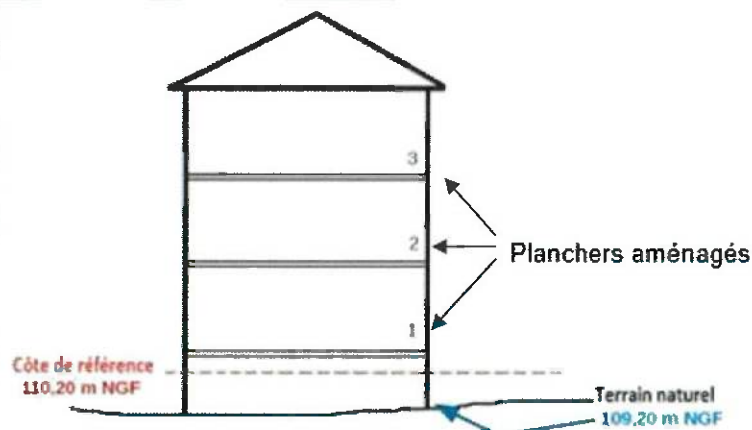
Construction avec 3 niveaux de planchers aménagés au-dessus de la cote de référence
